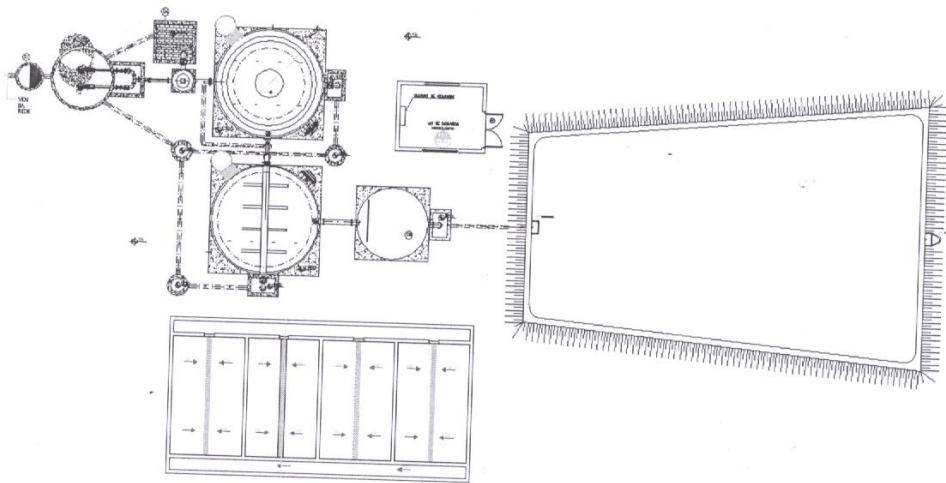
Layout da ETE do Canteiro de Obra CCASF
